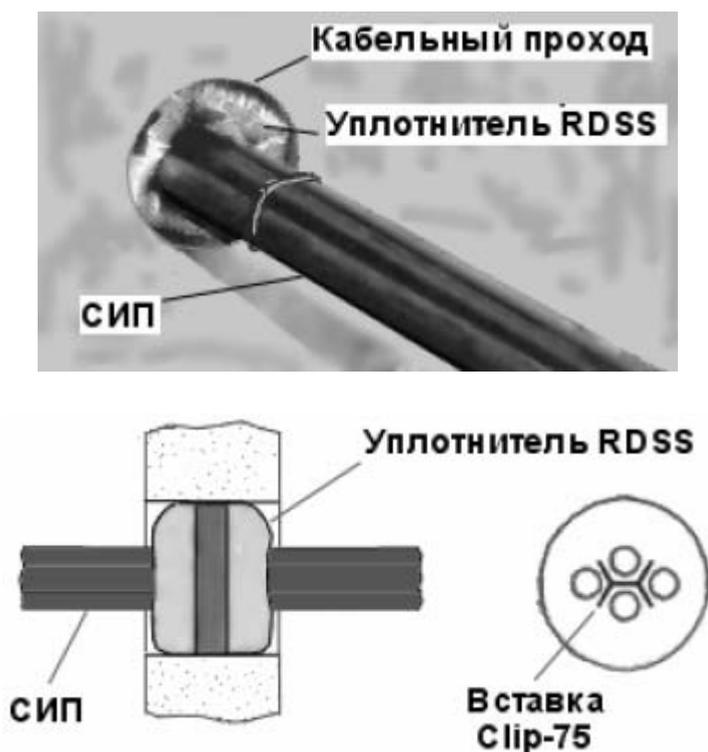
Внешний вид и схема расположения элементов уплотнителя типа RDSS
